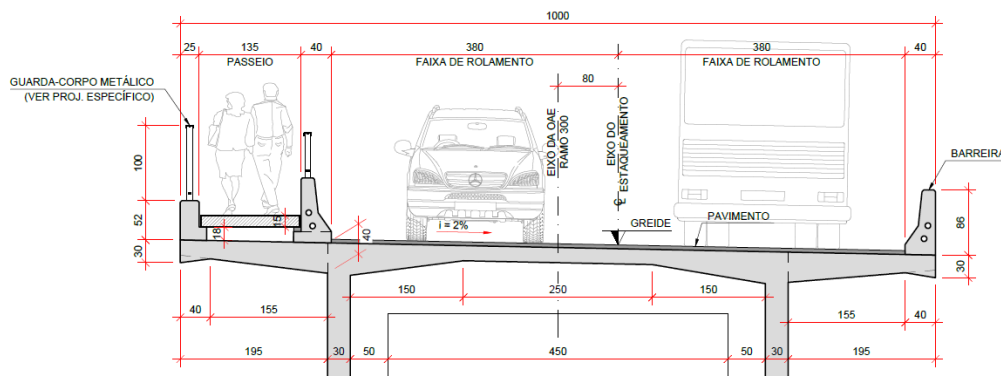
SEÇÃO TRANSVERSAL TÍPICA DO ENCONTRO ESTRUTURADO
